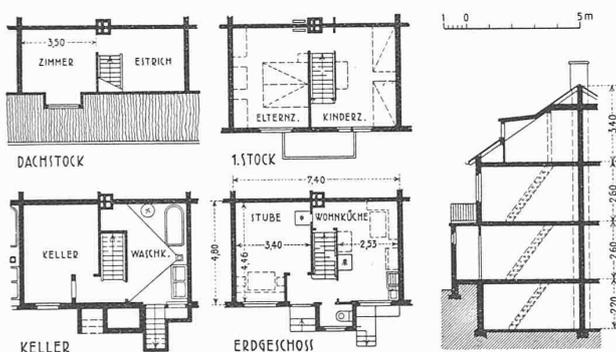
und 3. Eingebautes Haus; Grundrisse und Schnitt, 1 : 300.
